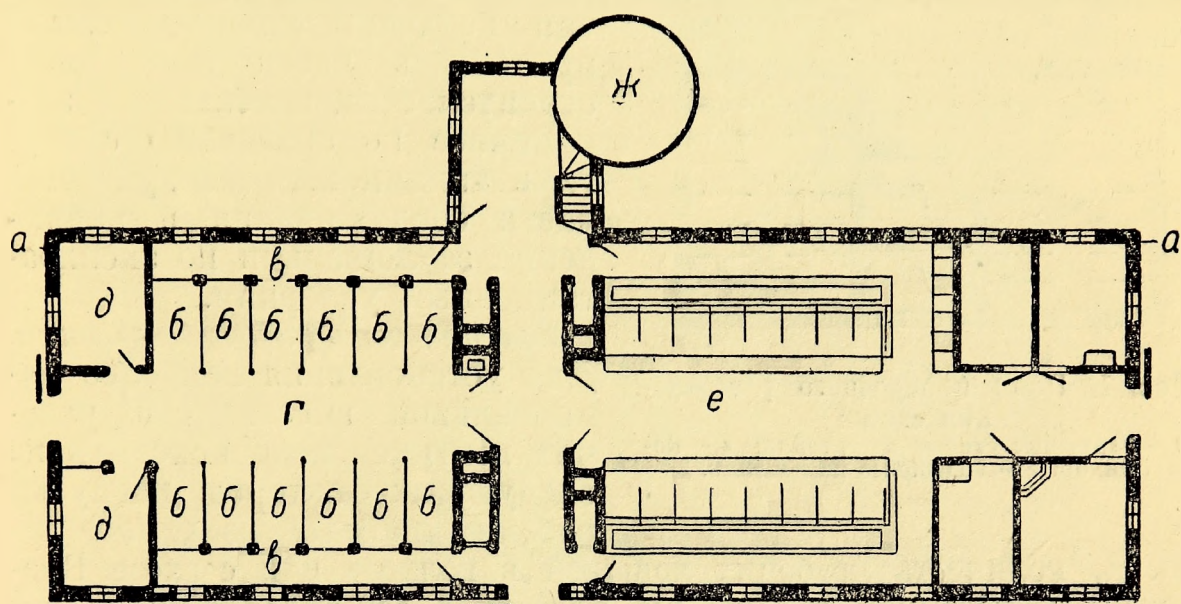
План двухрядной конюшни с двумя кормовыми коридорами, одним навозным коридором, с размещением лошадей головами к наружным стенам: а — наружные стены; б — стойла; в — кормовой коридор; г — навозные коридоры; д — денники; е — коровник, правая половина здания; ж — силосная башня.
